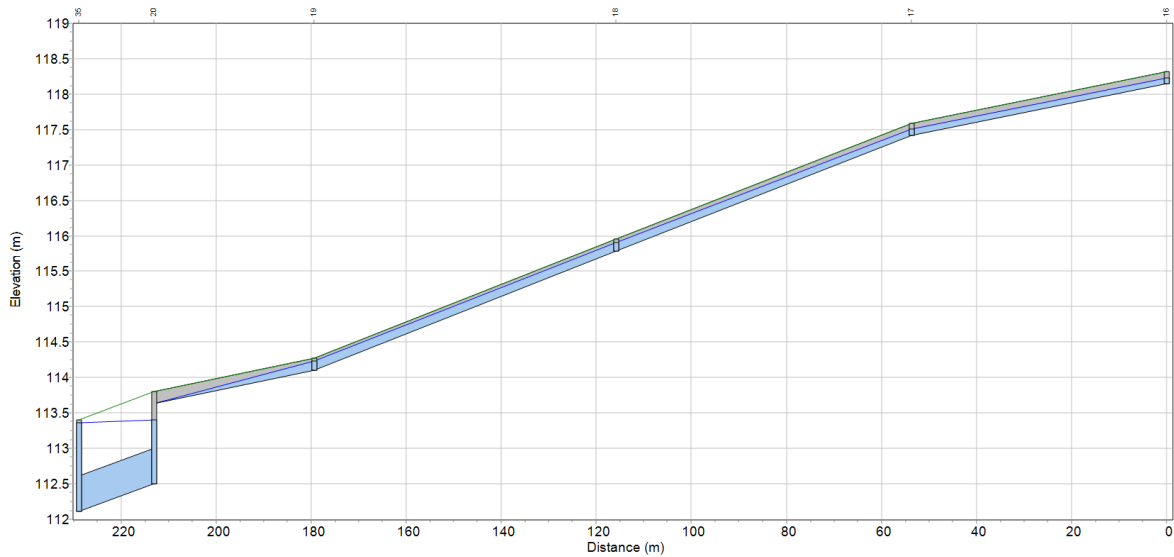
profilo disposto lungo la cunetta stradale posta a servizio dell'asse A, porzione est..
